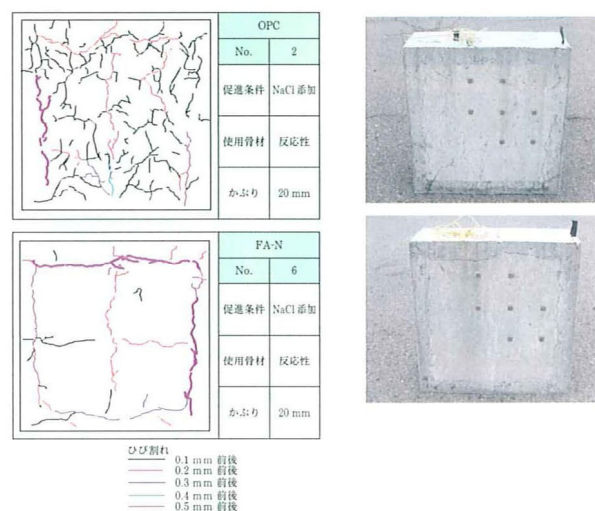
鉄筋コンクリート試験体の劣化状況（OPC および FA-N 15%、暴露期間 3 年）
